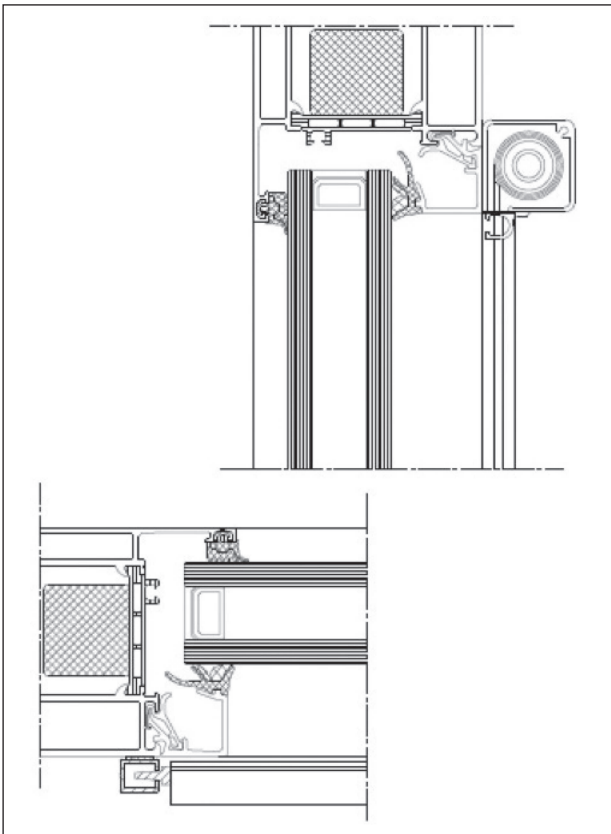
Rahmenmontage mit eckiger Kassette, Einbau auf dem Fenster-
